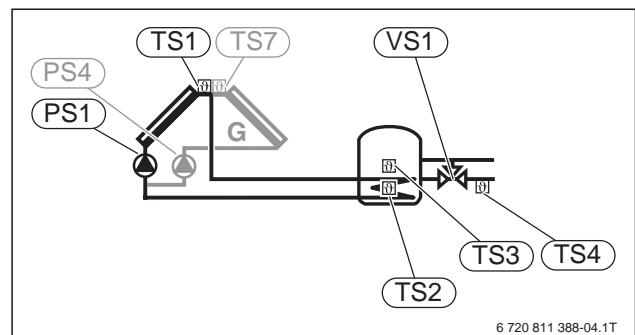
Hydraulikschema 1AG mit Solarmodul SM200 für 2 Kollektorfelder (Ost-/West-Schaltung)
